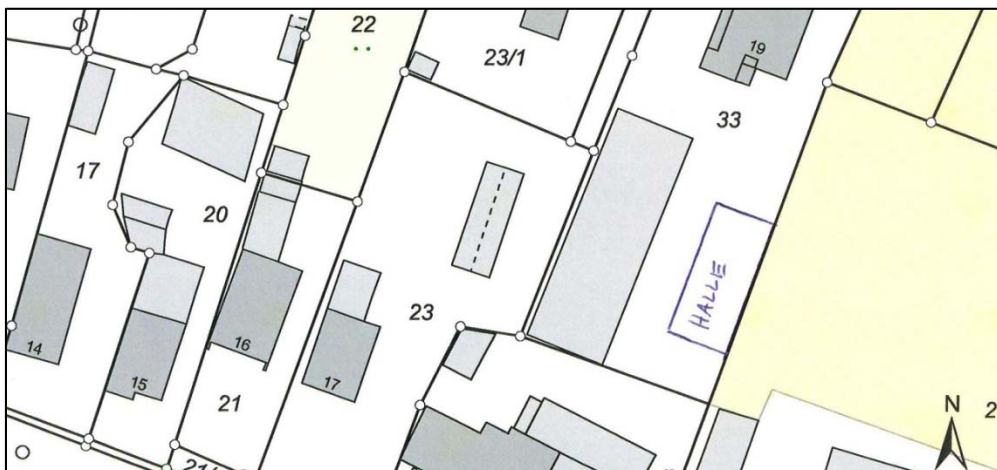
Lageplan mit Eintragung der neu geplanten Logistikhalle
